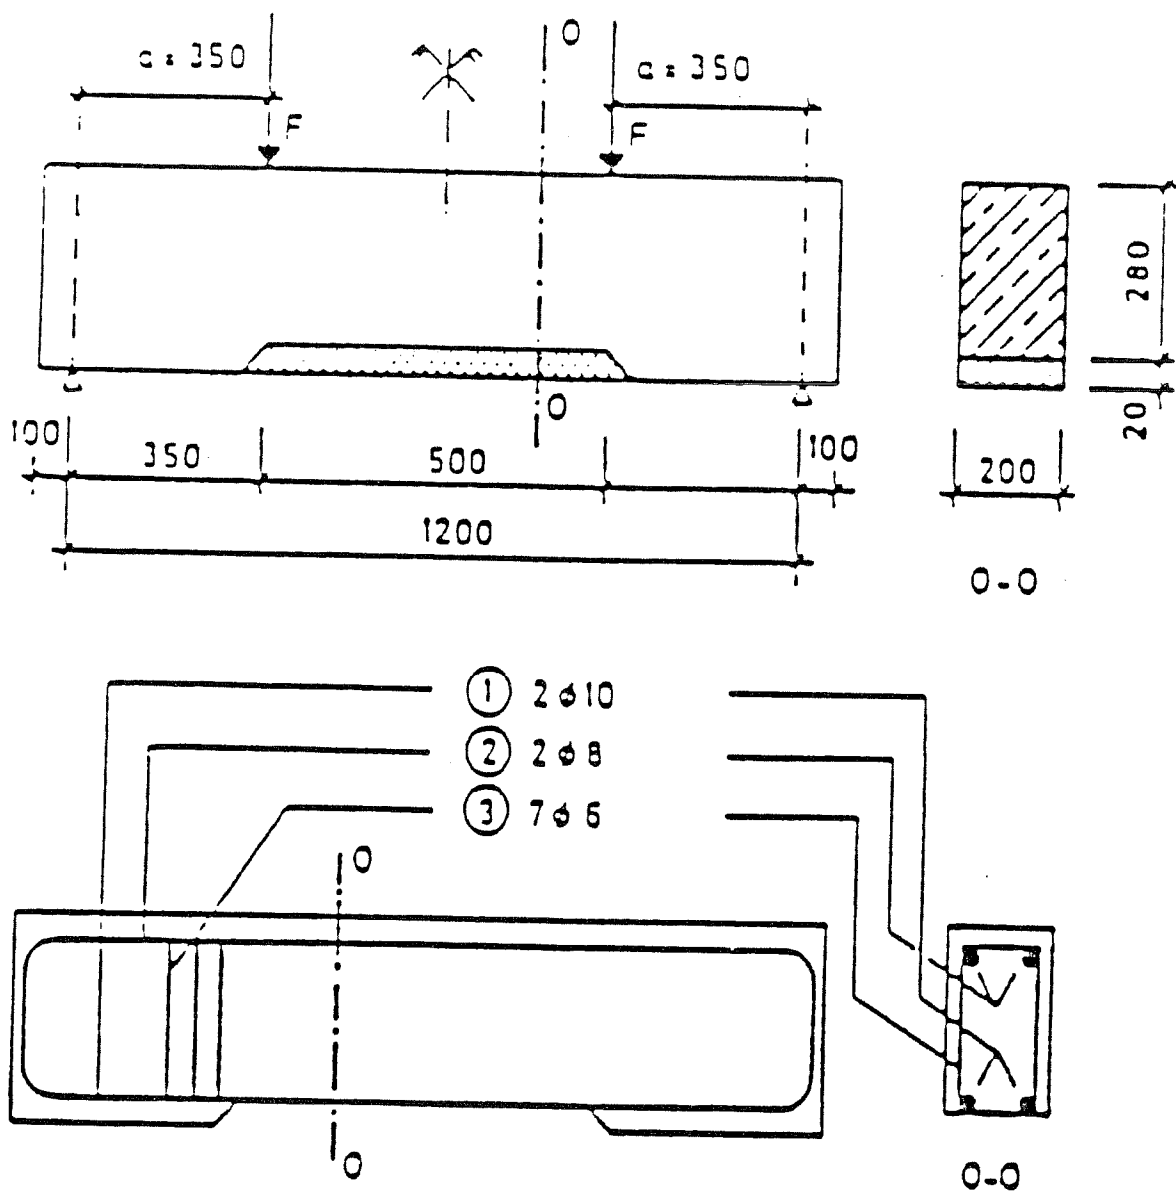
Forma e constituição da armadura da viga em betão armado utilizada no ensaio de solitação dinâmica.
